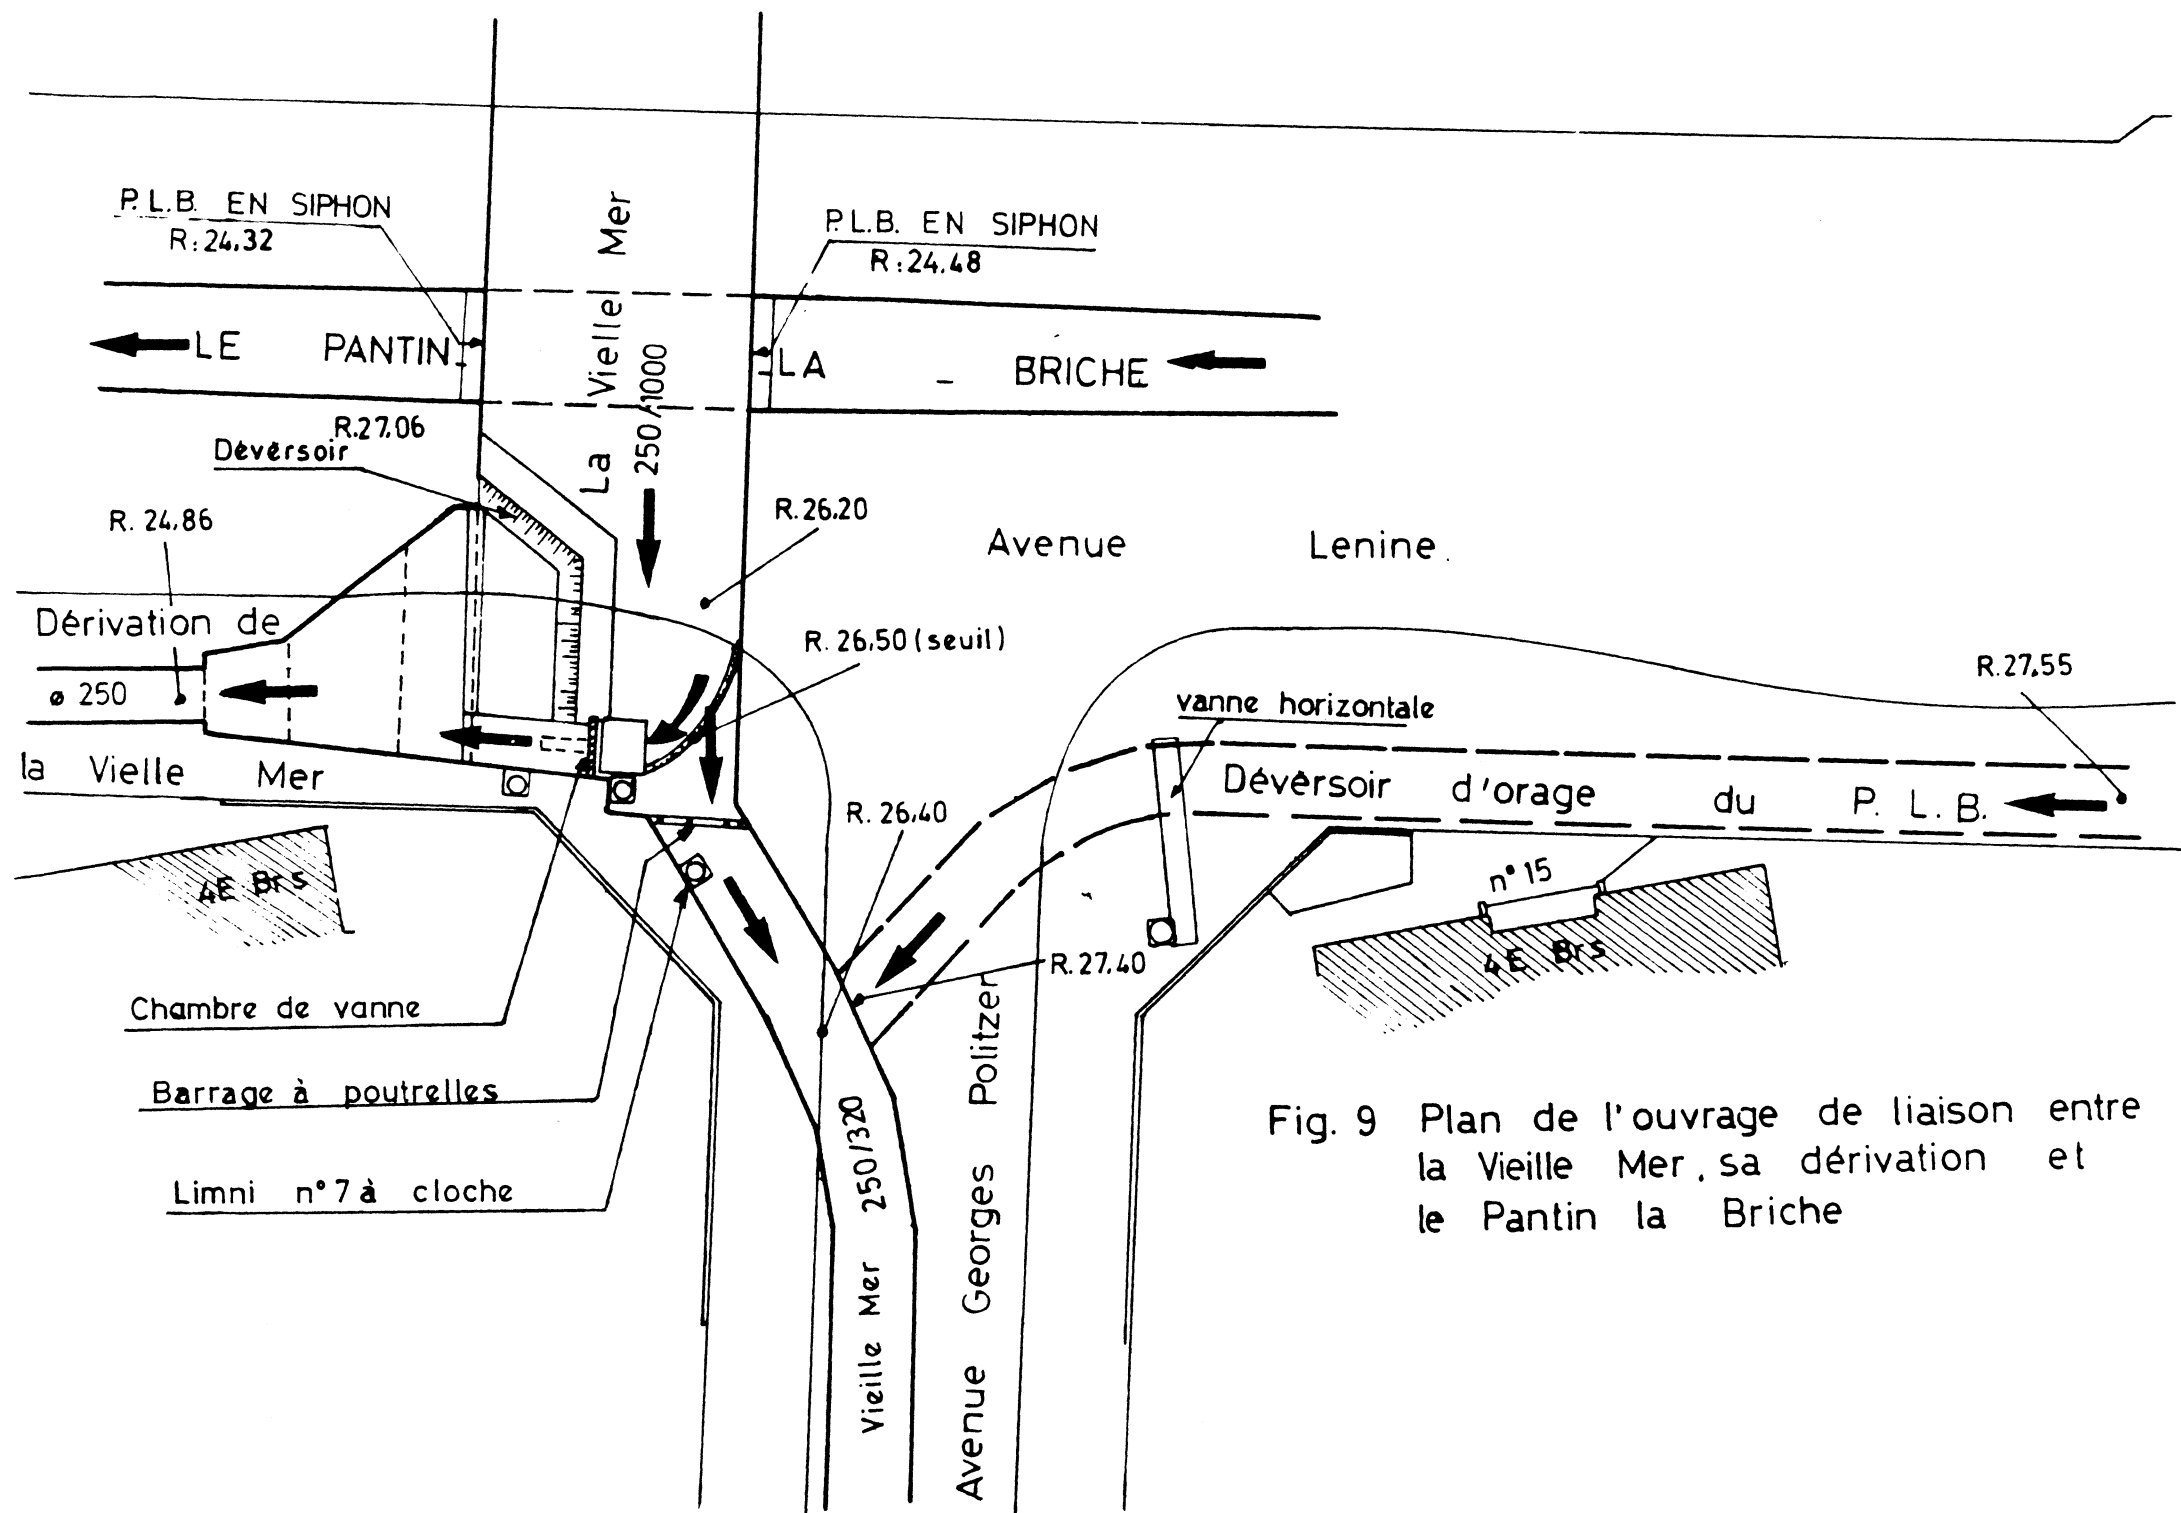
Plan de l'ouvrage de liaison entre la Vieille Mer, sa dérivation et le Pantin la Briche
